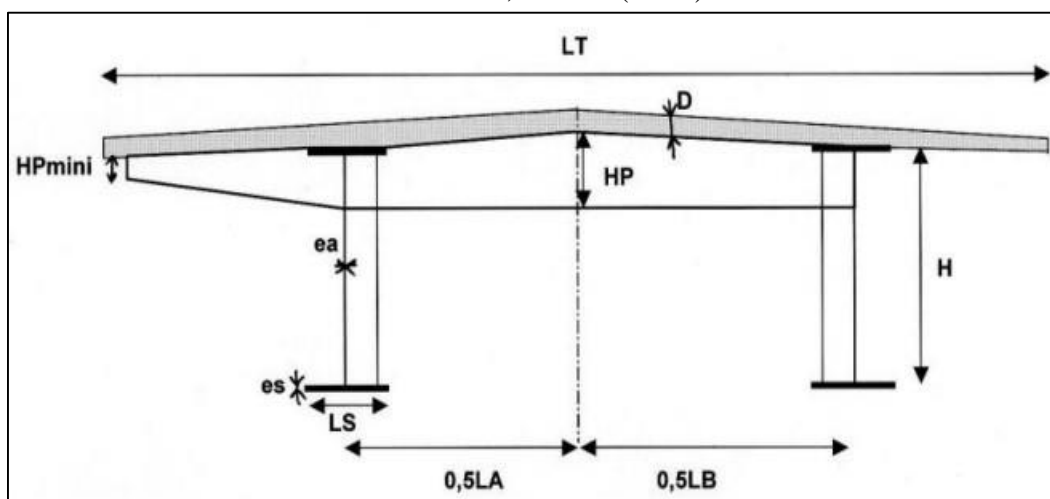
Détails des dimensions d'un tablier bipoutre avec consoles.
